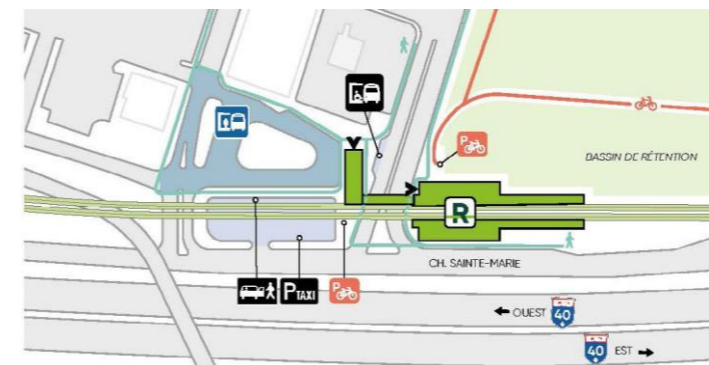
Plan d'implantation préliminaire de la station Kirkland
